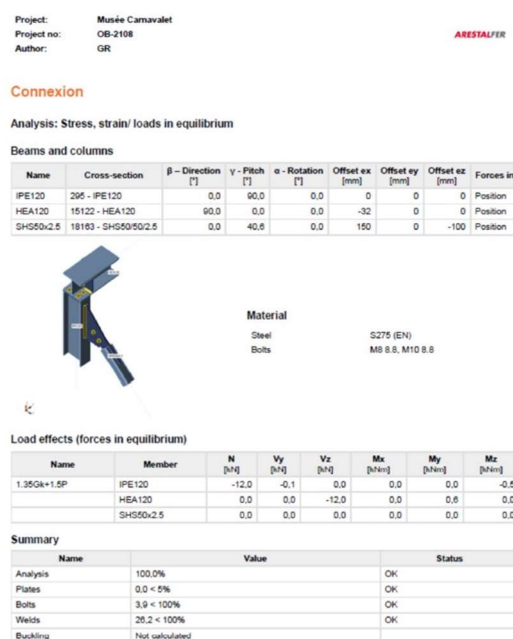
Ligação aparafusada pilar-viga-travamento – Musée Carnavalet: pórtico metálico 1
